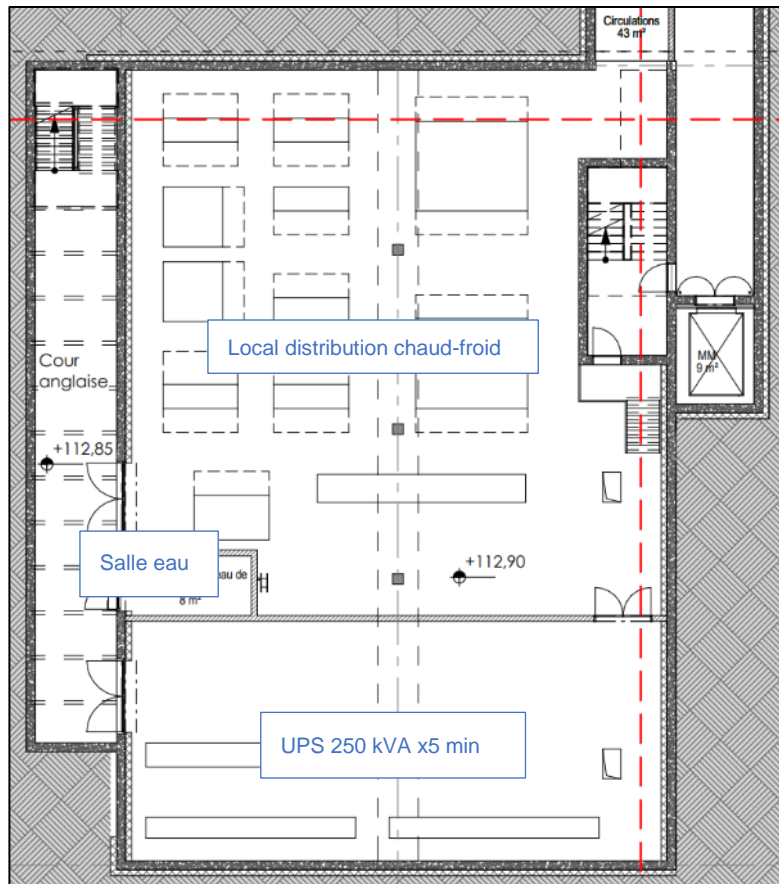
Positionnement des installations (Power house – niveau R-2)
